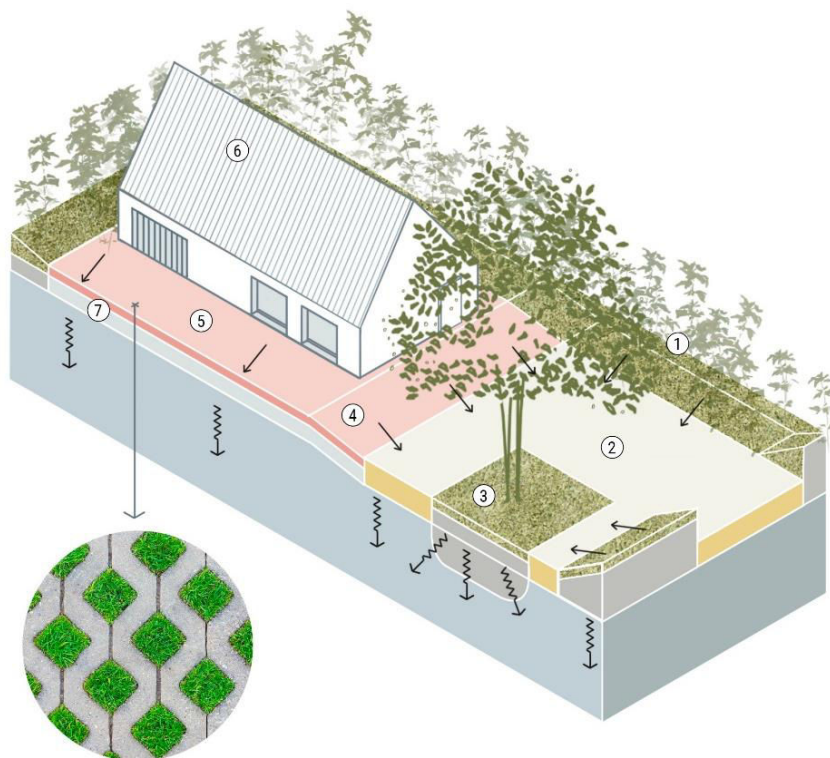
Soluții de amenajare teren - vecinătate construcții. 1 - dig, bermă, terasament de protecție a proprietății sau zid impermeabil; 2 - zonă carosabilă – sistem rutier permeabil; 3 - spațiu verde cu umplutură din pietriș grosier sau piatră spartă în partea inferioară și tub perimetral de drenaj cu diametru mai mare de 80 mm prevăzut cu sistem de infiltrație a apei în sol; 4 - pantă ascendentă spre clădire sau terasă, cu rol de încetinire a procesului de inundare pentru a permite punerea în siguranță a clădirii și bunurilor; 5 - zonă de circulație pietonală – sistem permeabil; 6 – clădire; 7 - umplutură de pământ.
